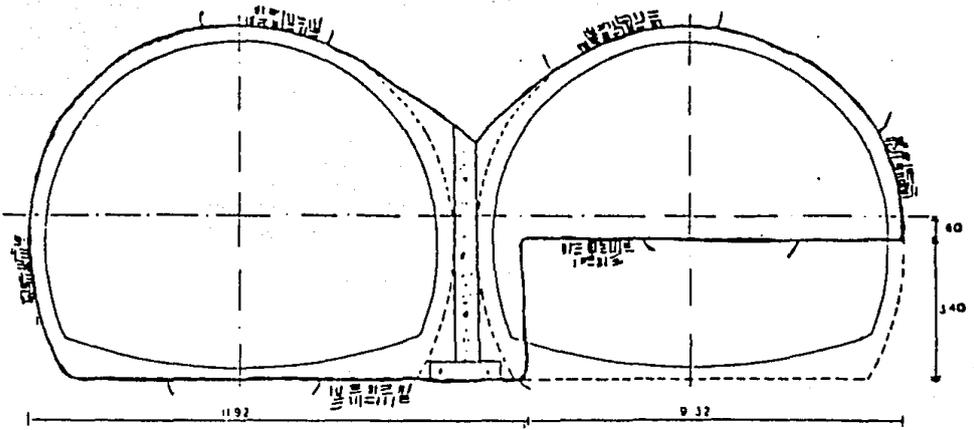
TERCERA ETAPA DE EXCAVACION
